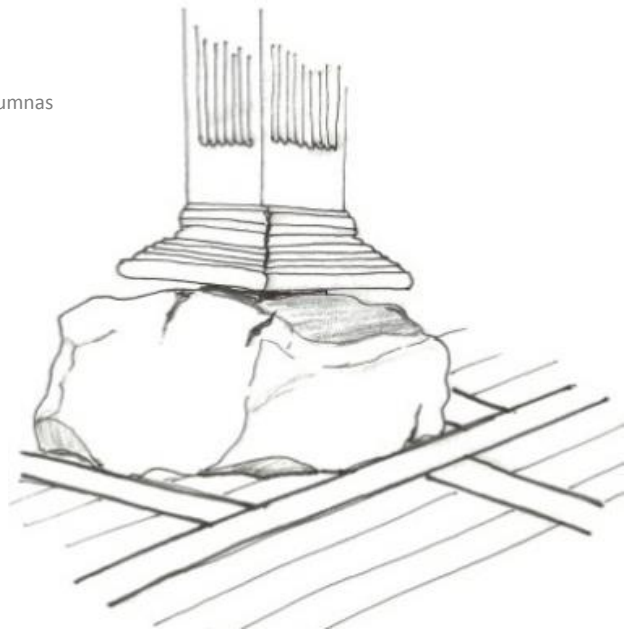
Iglesia de Achao, croquis detalle suelo madera y apoyo columnas
